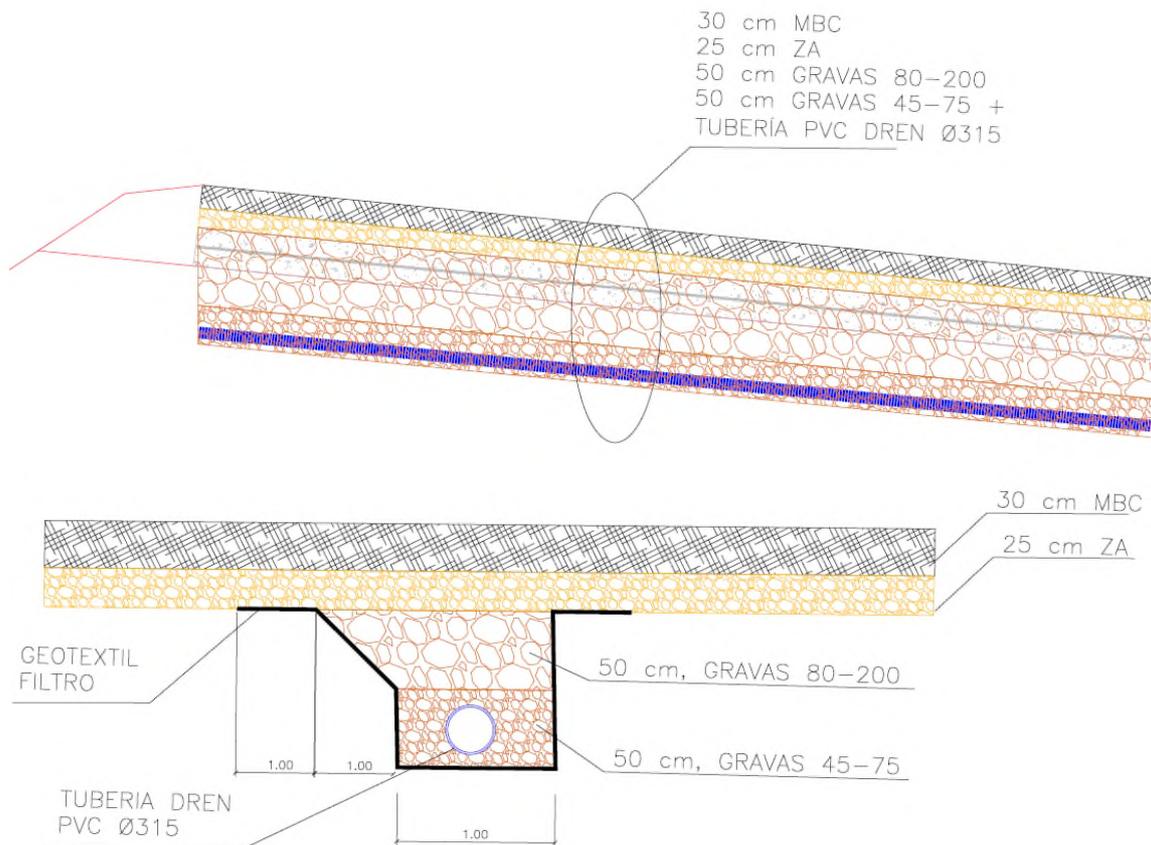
Ejecución a posteriori: secciones transversal y longitudinal a la carretera, detalles de la zanja de la Foto 24
